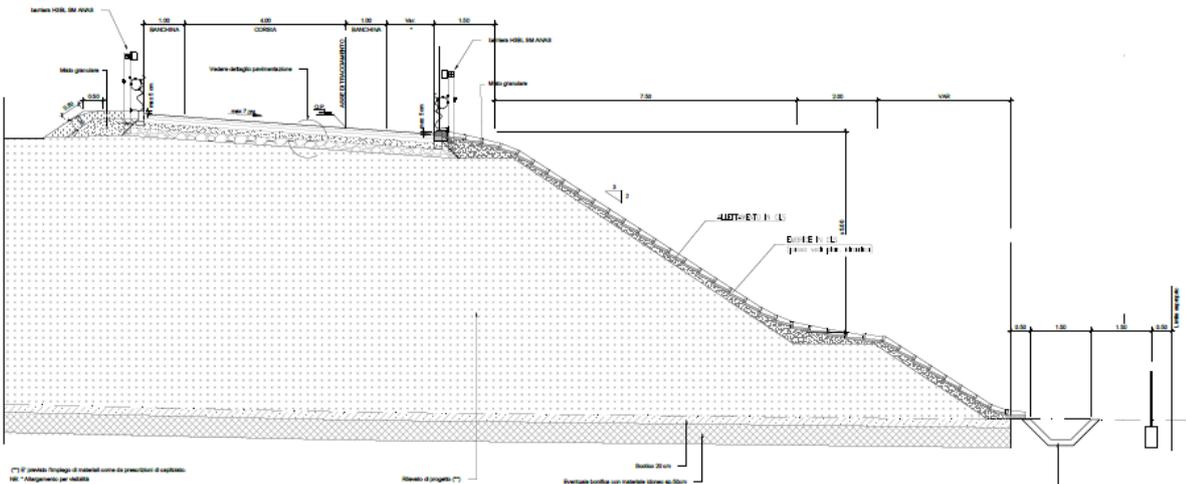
Sezione tipo rampa monodirezionale (Rampa B)
